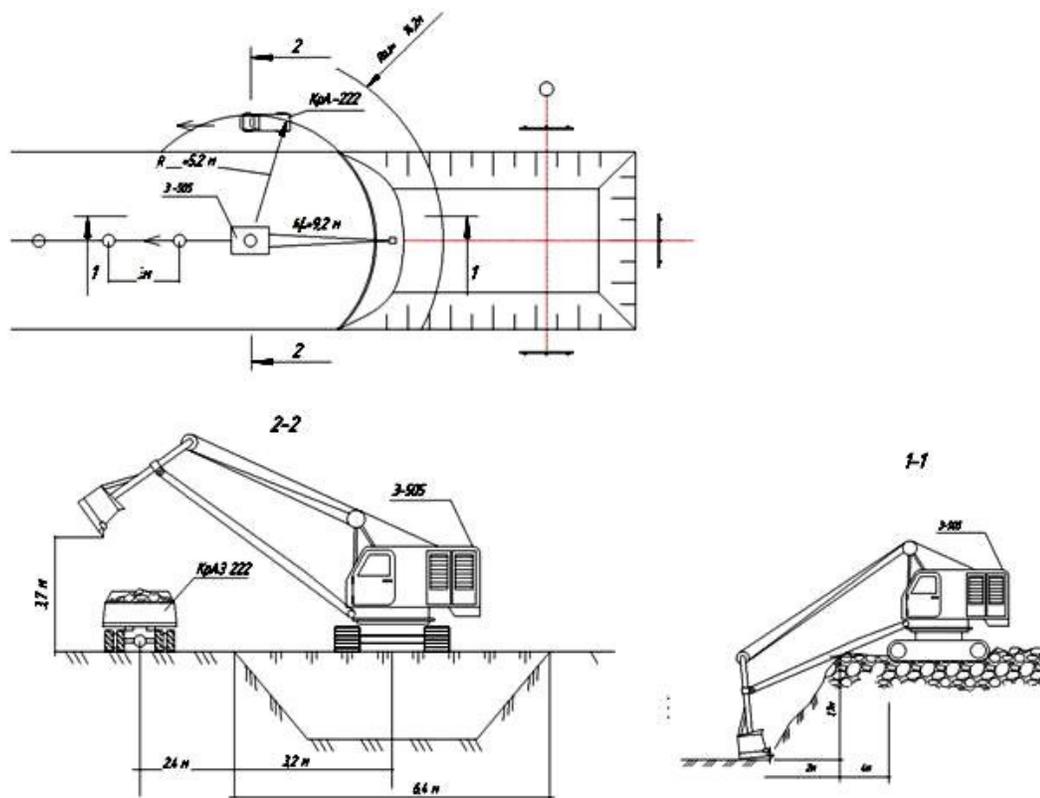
План размещения оборудования при проведении земляных работ по разработке котлована фундамента
